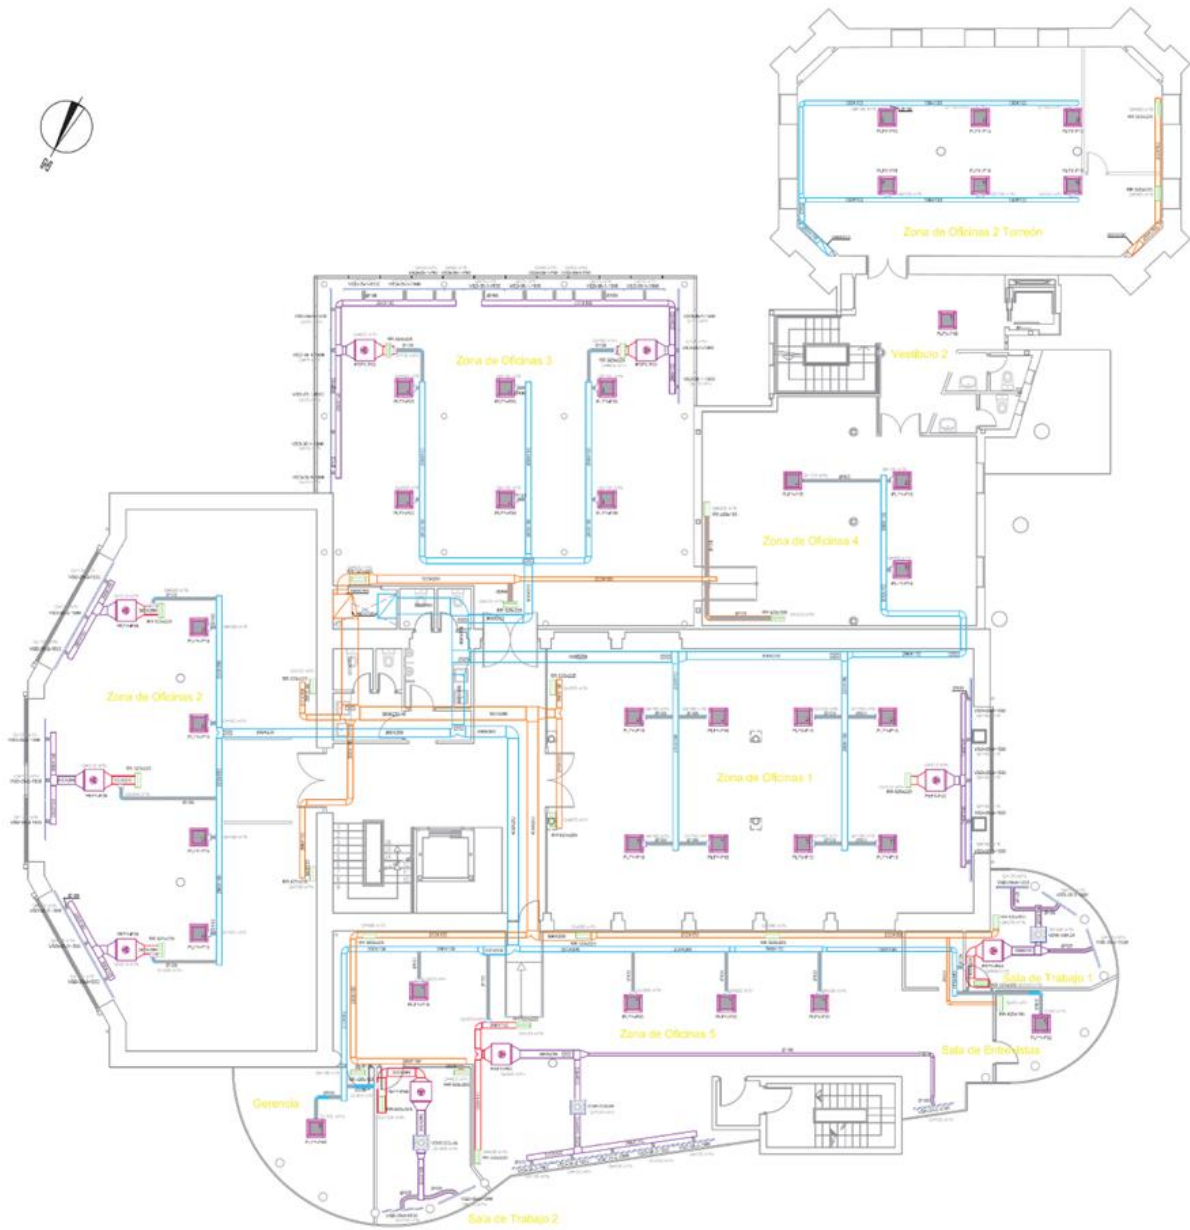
Unidades terminales planta Primera y Segunda del Torreón
